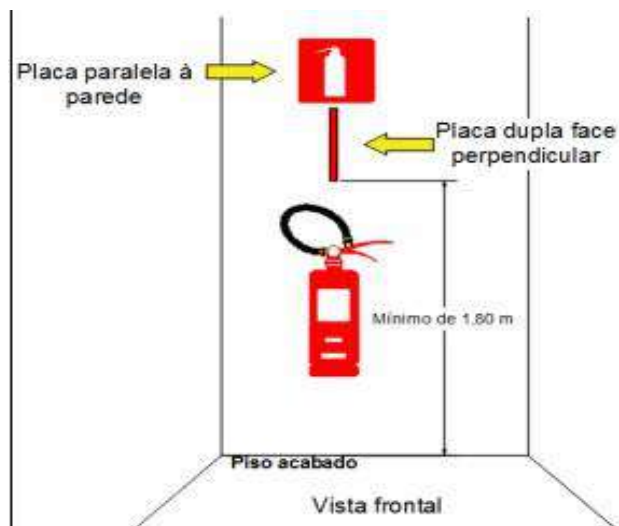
Placa com indicação extintor deve ser colocada a 1,80 do piso do chão.
